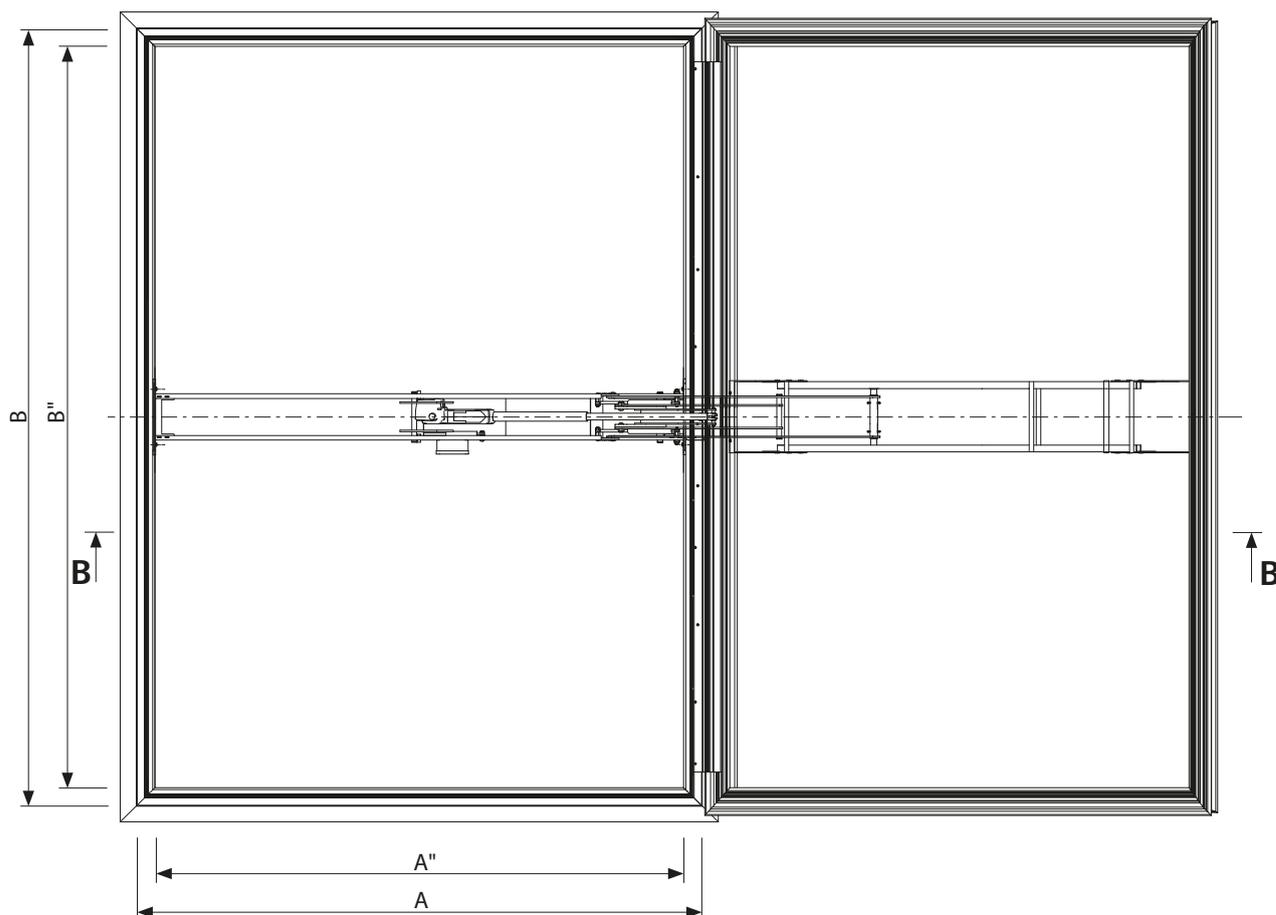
Draufsicht von einem RWA-Gerät mcr ULTRA THERM Typ NG-A mit schrägem PVC-Aufsatzkranz in Dachausstiegsausführung in geöffneter Position
